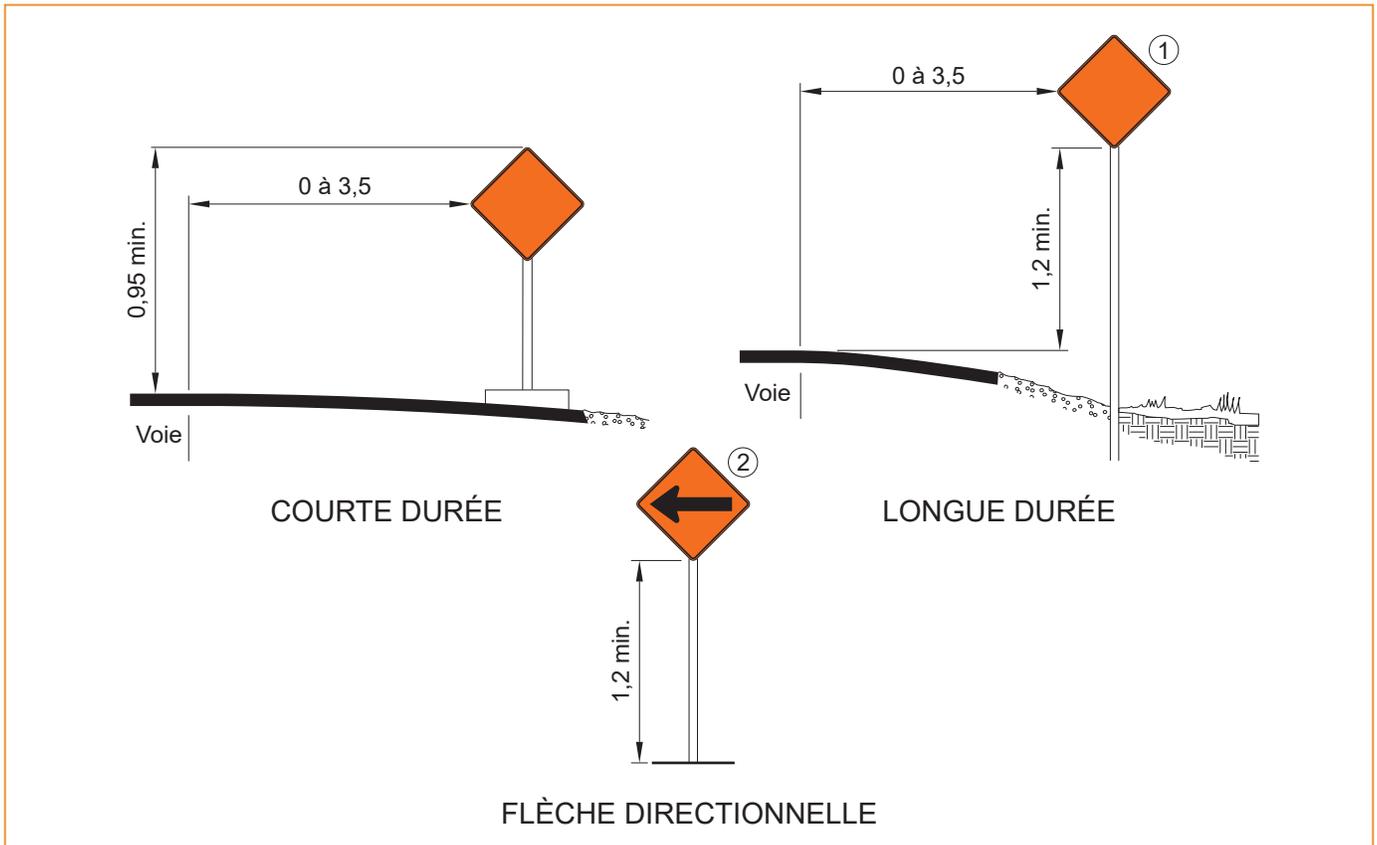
Extrait du dessin normalisé 002 «Détails d'installation des panneaux de travaux» concernant la hauteur de dégagement sous le panneau «Flèche directionnelle» (T-D-130-1).
